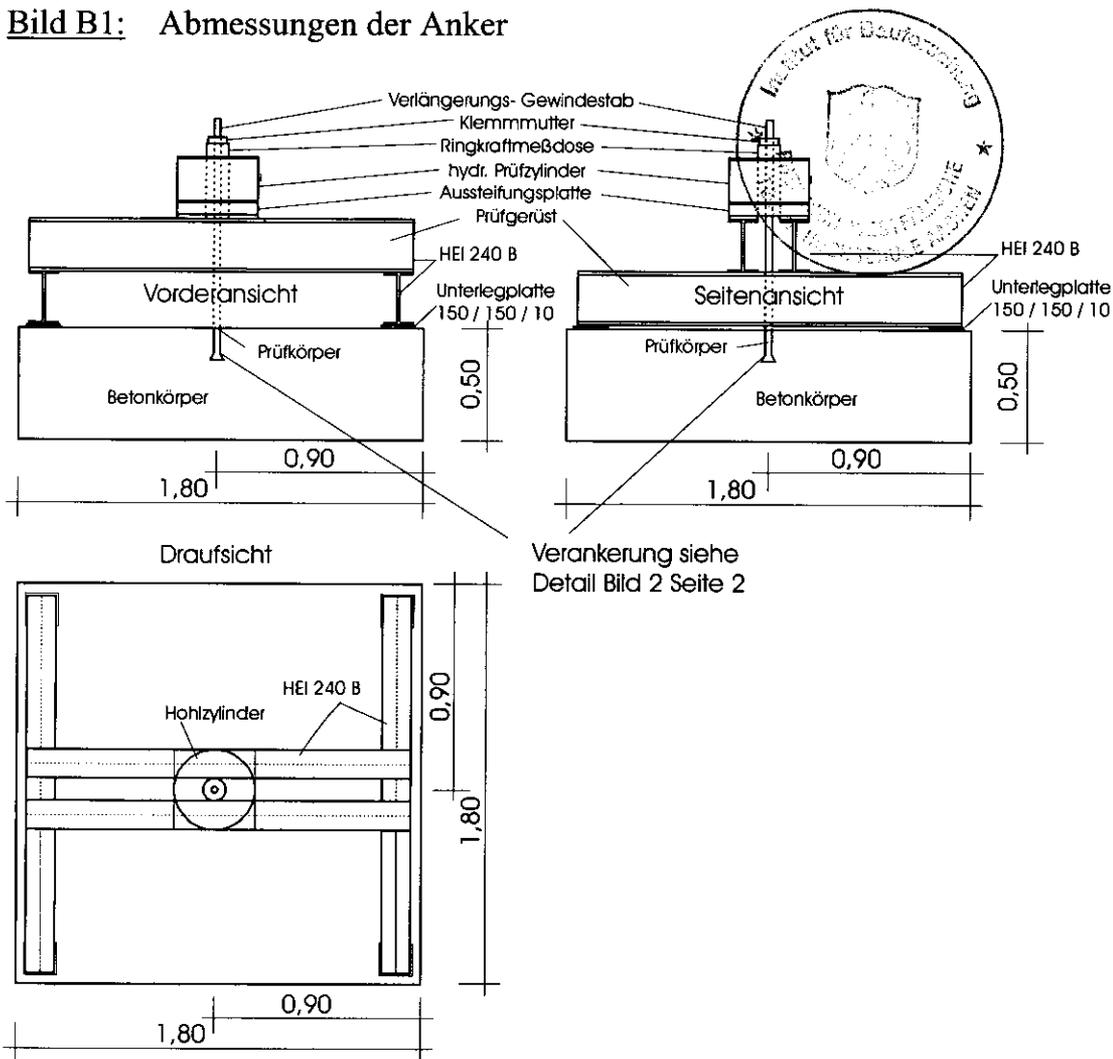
Statischer Prüfaufbau der Verankerungsversuche mit Betonprüfkörper aus B 25
